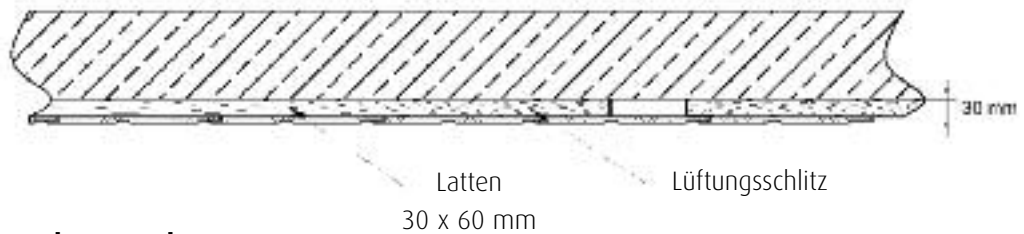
Senkrechte Montage der Ultra-Plank / Ridgewood Fassadenelemente
